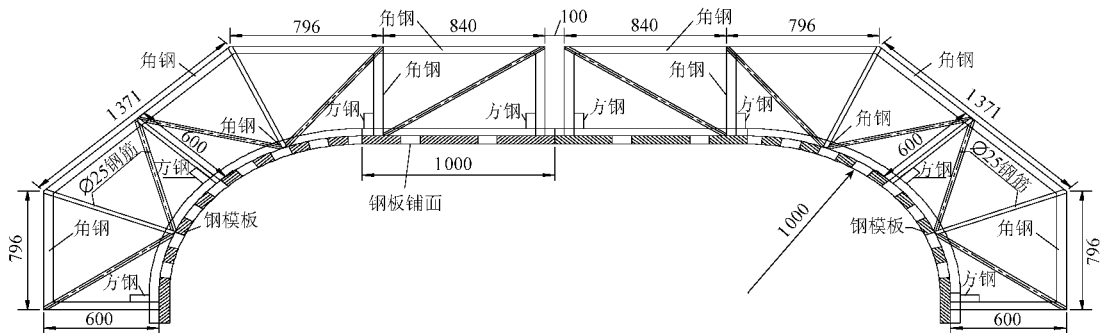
泄水闸滑模墩头模板示意图(单位:mm)
